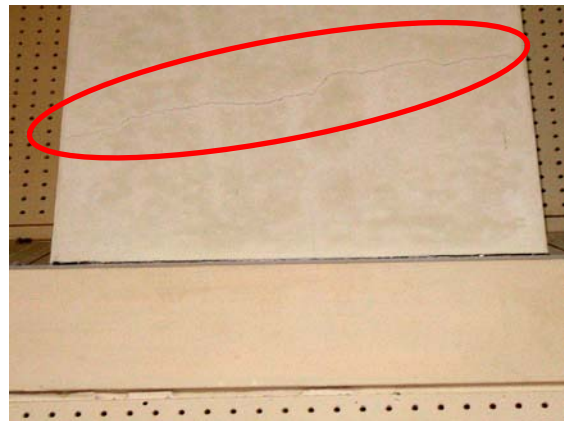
体育館の柱に生じた曲げひび割れ
